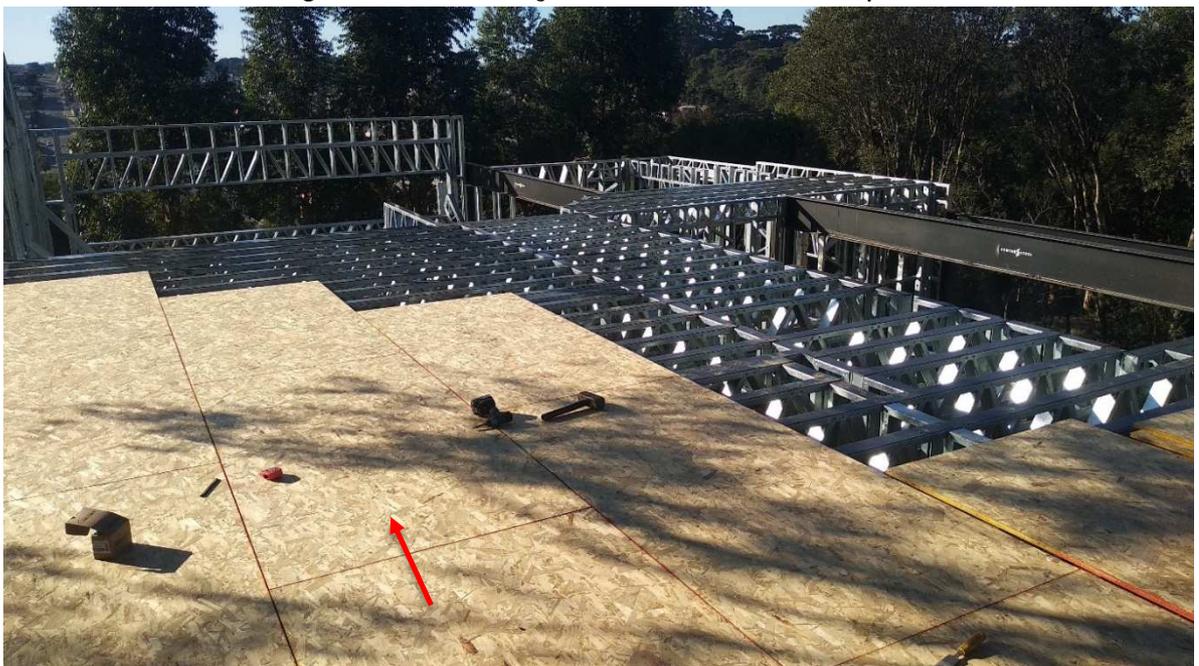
Vigas treliçadas sobre as estruturas de painéis e banda acústica
